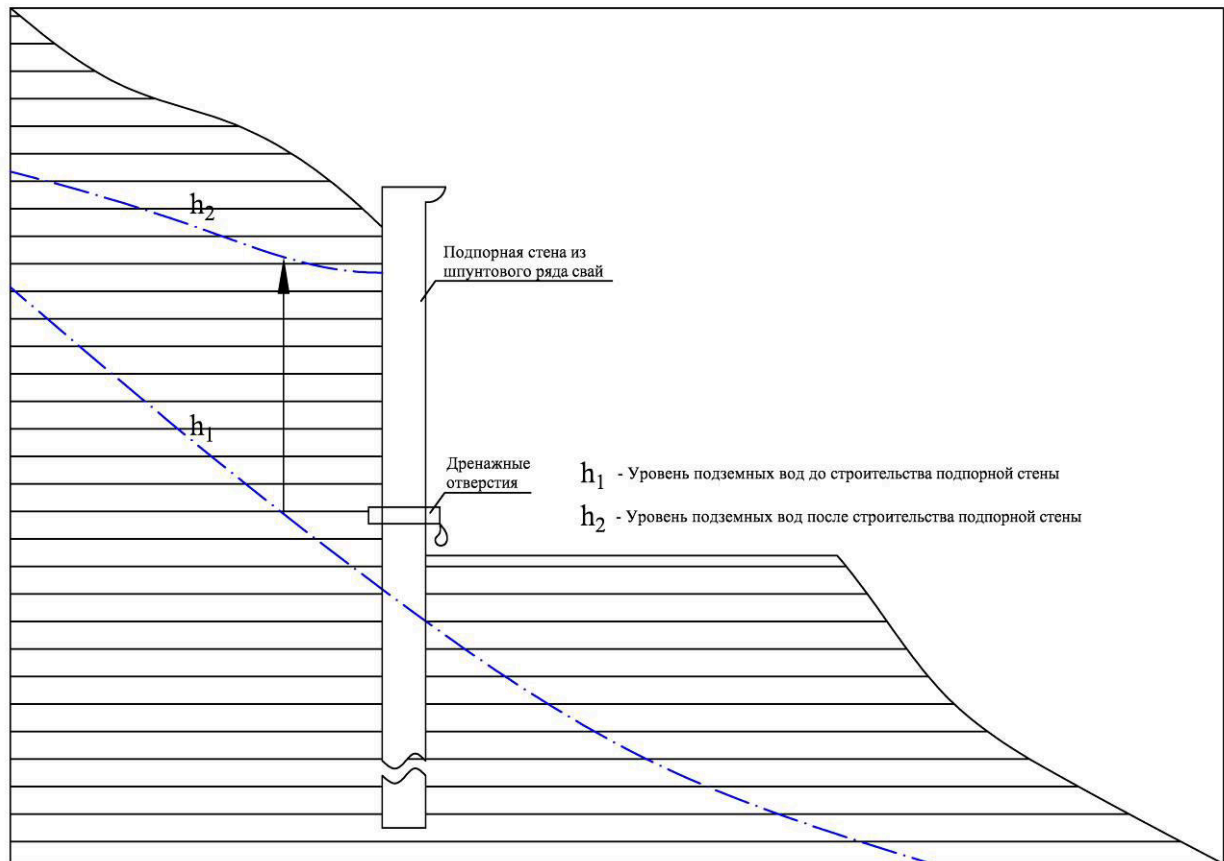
Строительство подпорной стены из сплошного шпунтового ряда свай без организации эффективного дренажа подземных вод.
